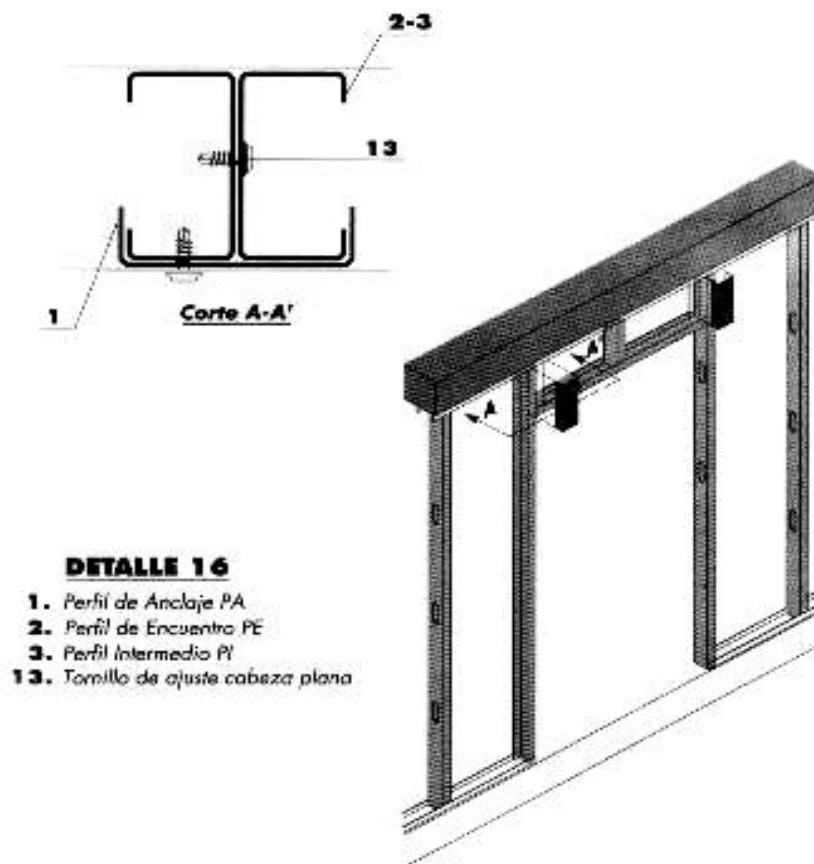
Estructura metálica, ensamblado para formar vano de puertas.
